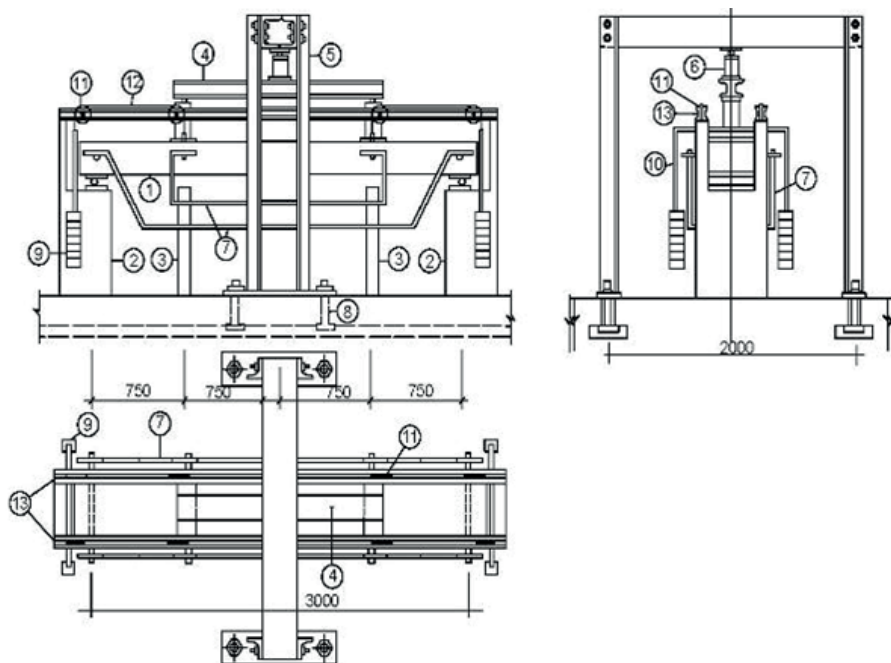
Схема стэнда для испытания балок: 1 — балка; 2 — опоры; 3 — страховочные опоры; 4 — распределительная балка; 5 — силовая рама; 6 — гидравлический домкрат; 7 — металлические рамки; 8 — анкерующие болты; 9 — грузы; 10 — подвеска; 11 — блоки; 12 — трос; 13 — балки из швеллеров
